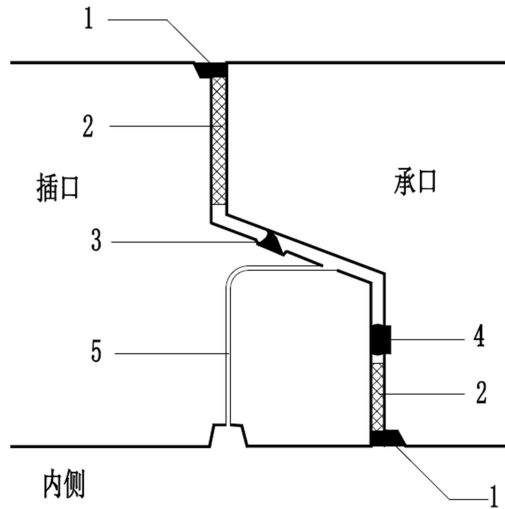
纵向锁紧承插接头密封防水构造
